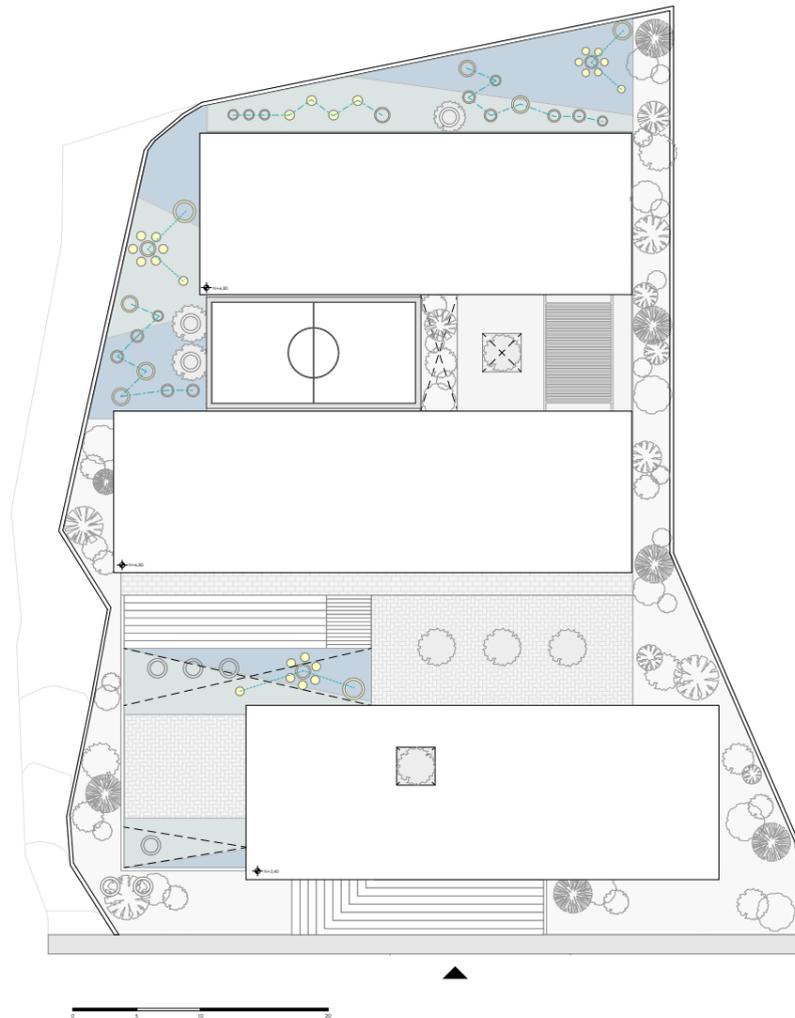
Planta cubiertas. Fuente: Elaboración propia.
